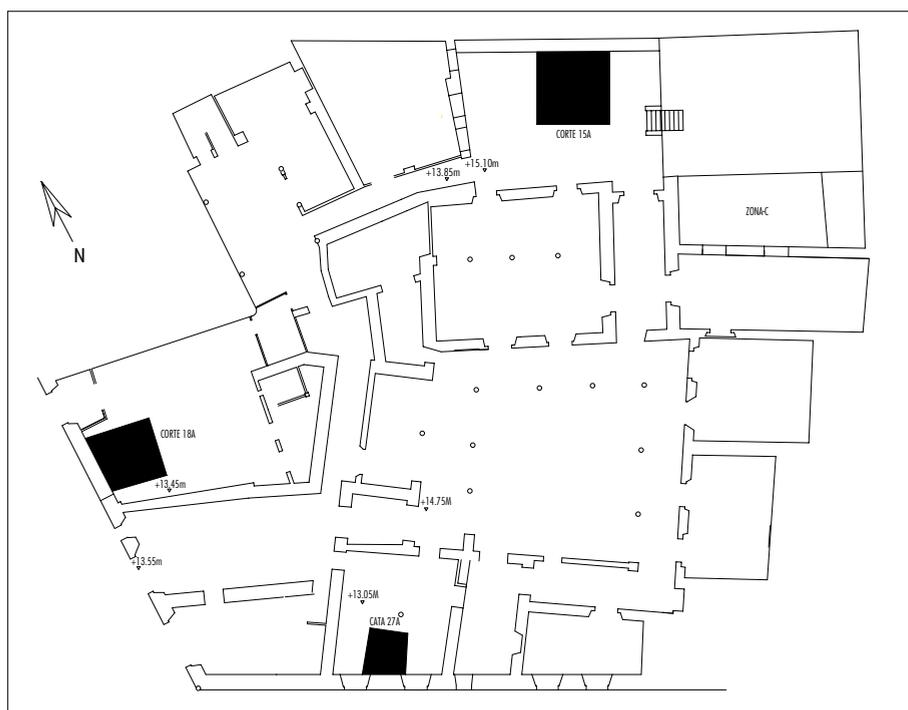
Corte 15A. Planta del edificio con ubicación de cortes.
